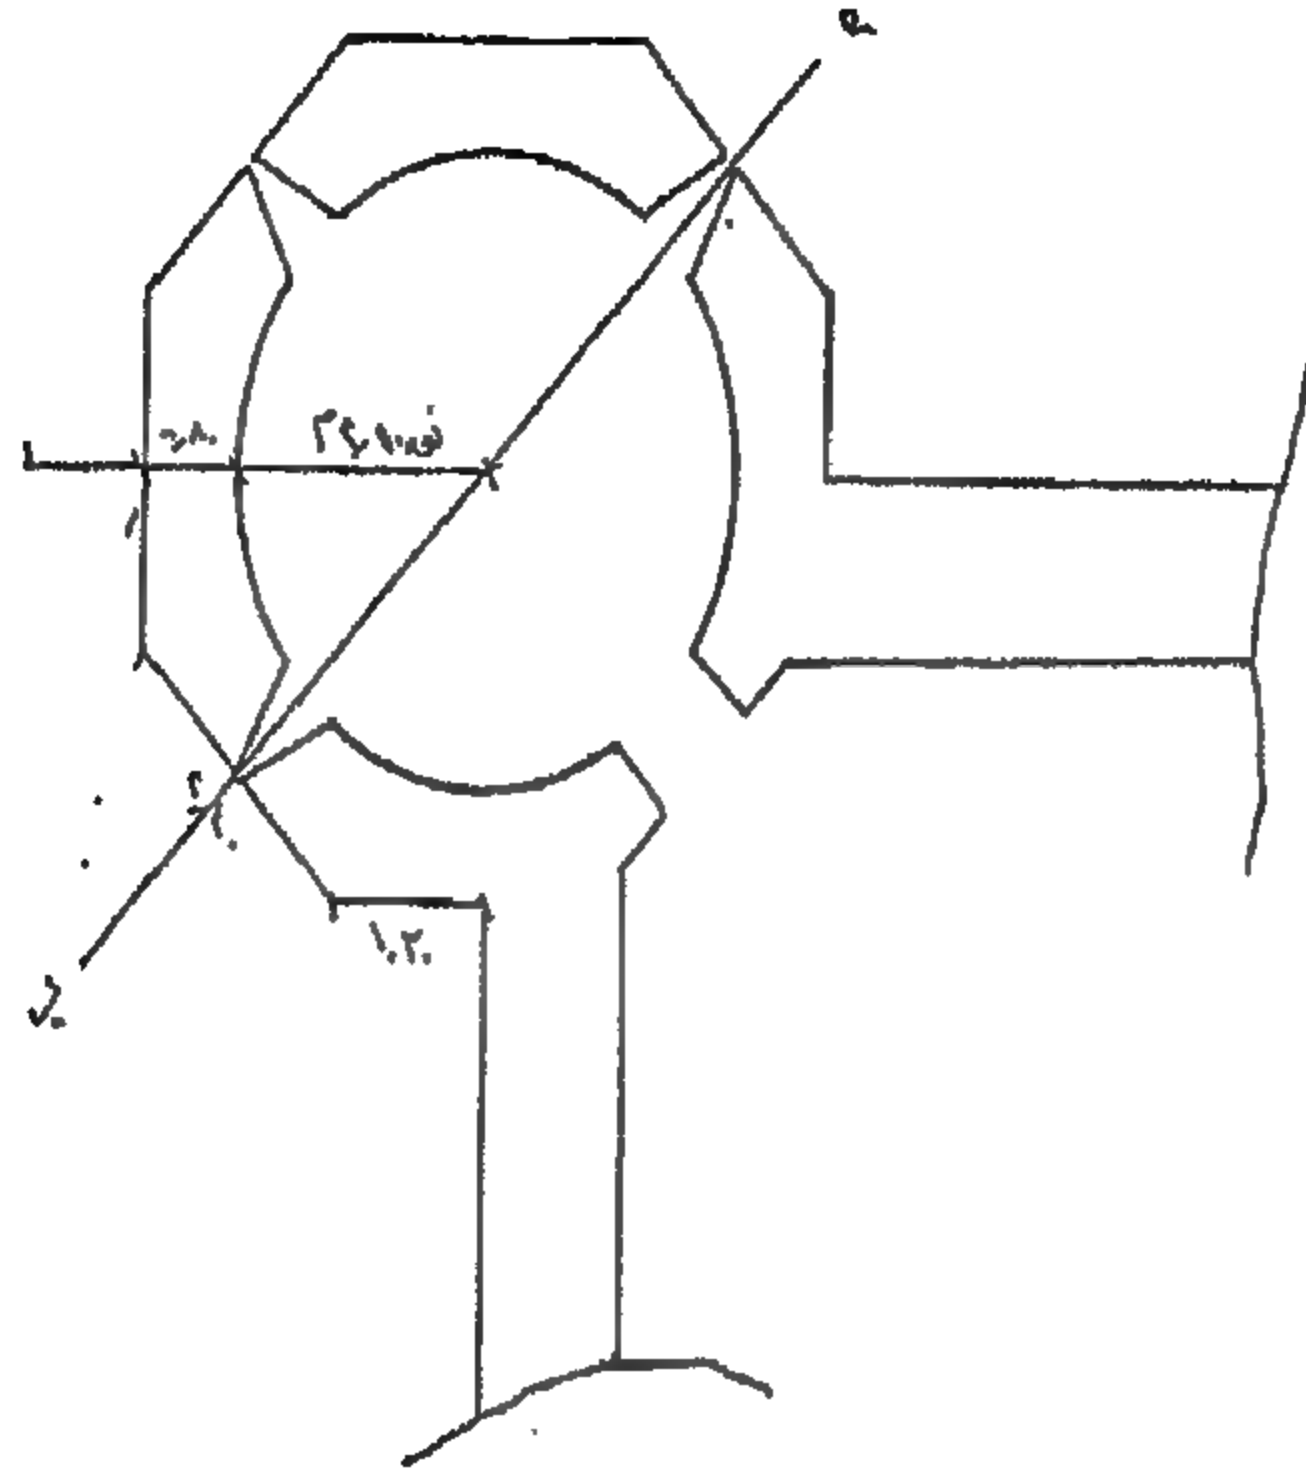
مسقط أفقي للطابق السفلي لقلعة الأزيم بمقياس رسم ١: ٢٠٠ عن:
